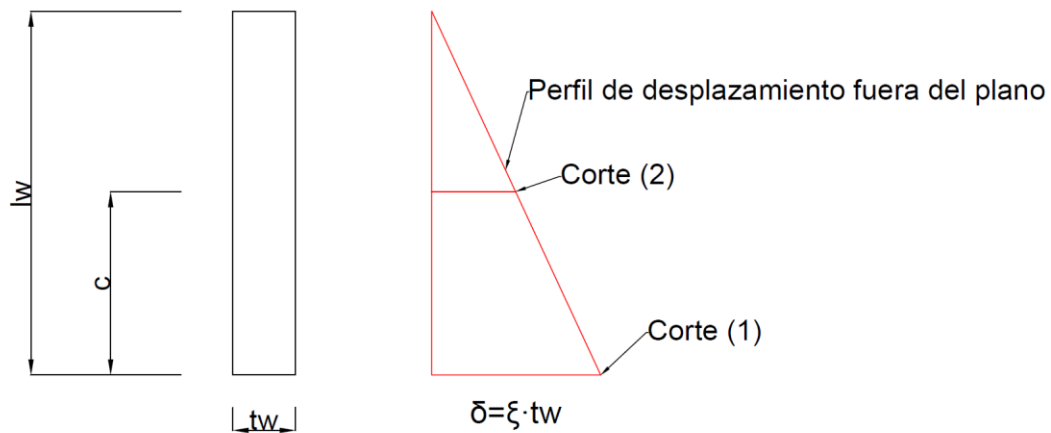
Esquema geometría y perfil de desplazamientos fuera del plano
